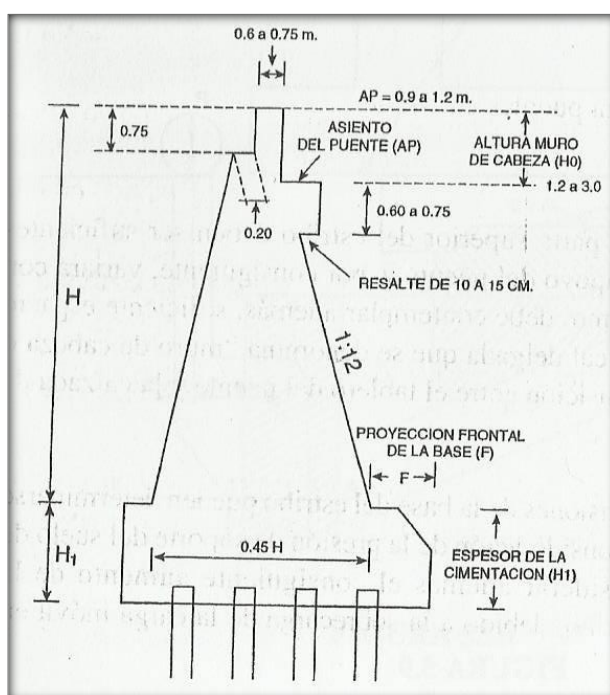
Geometría y predimensionamiento de un estribo de mampostería
